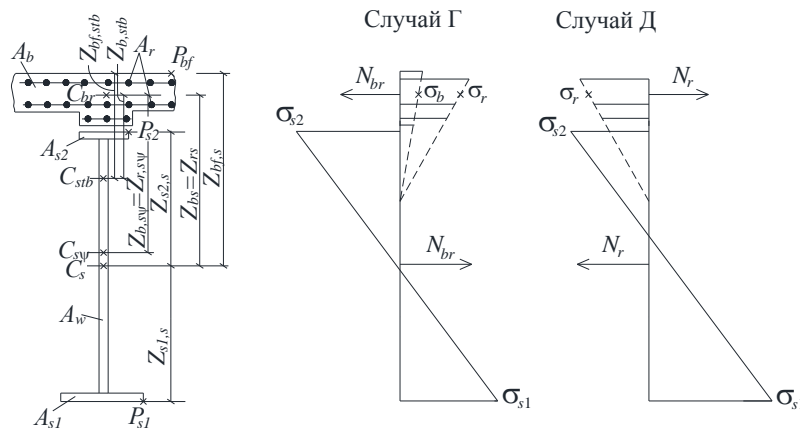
Усилия и напряжения в сталежелезобетонном поперечном сечении, воспринимающем отрицательный изгибающий момент
